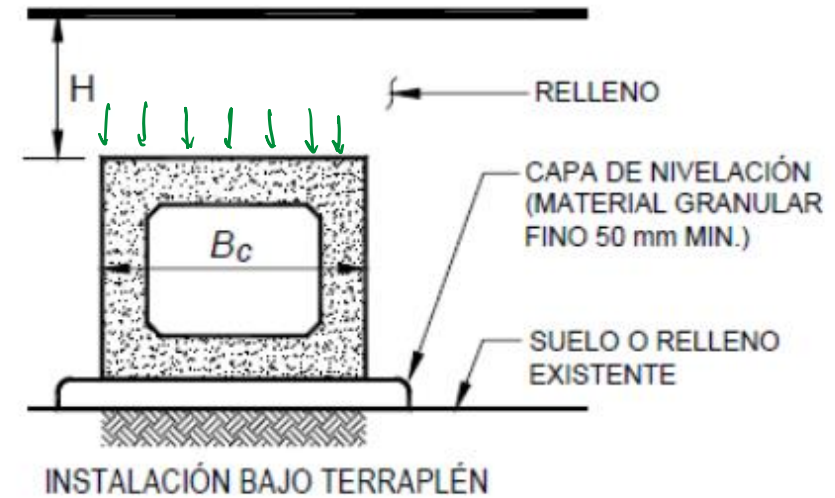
Instalaciones bajo terraplén — Secciones tipo cajón de concreto prefabricado
